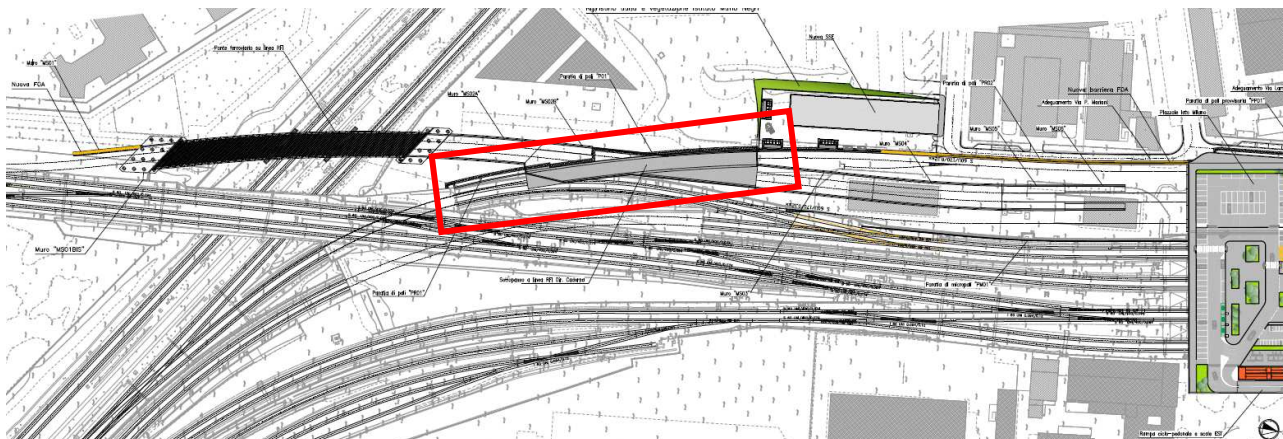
Planimetria generale opere con indicazione del manufatto scatolare.
